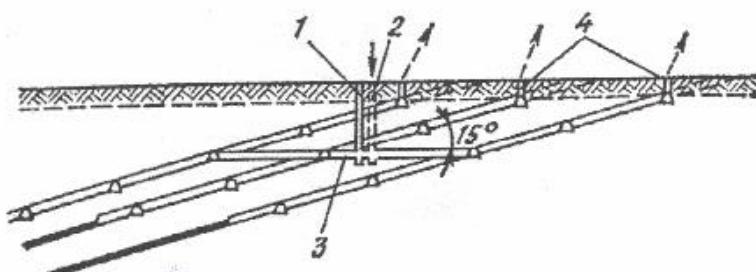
Схема вскрытия пластов вертикальными стволами без дополнительной вскрывающей выработки
